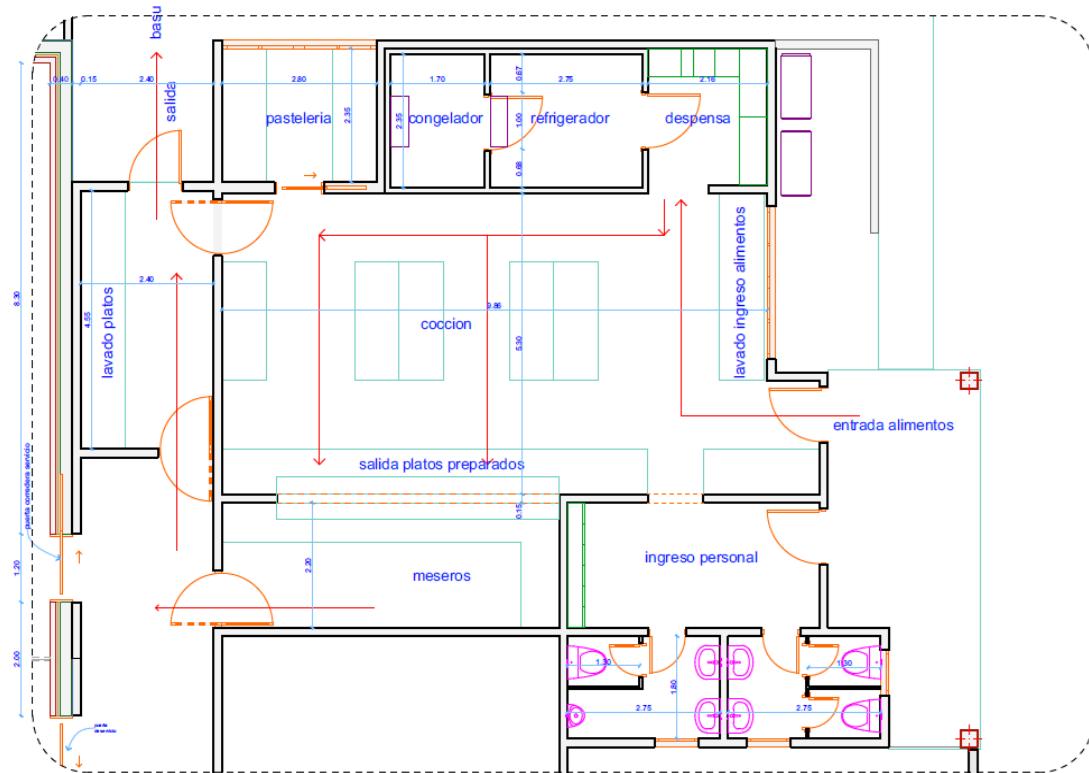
Detalle típico de las Distintas Infraestructuras
